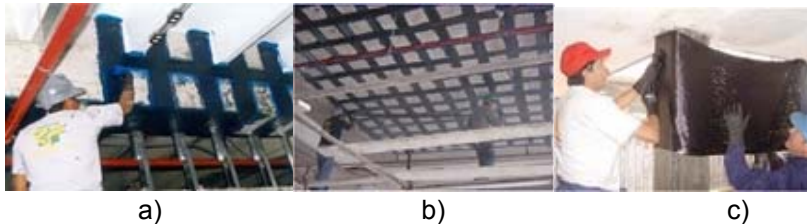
Reforzamientos de elementos de hormigón armado con tejidos de PRF.
